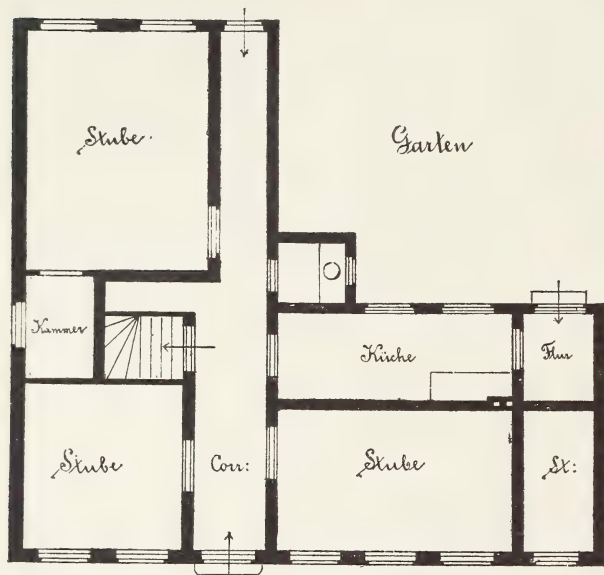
Grundriss. Pfarrhaus. Monnikendam.
